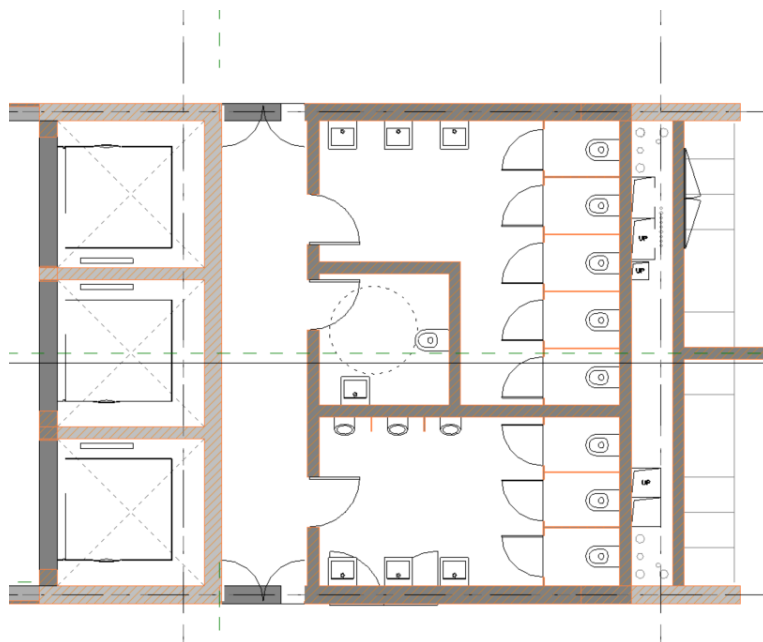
Compatibilização entre o modelo estrutura e arquitetura (vista em planta)
